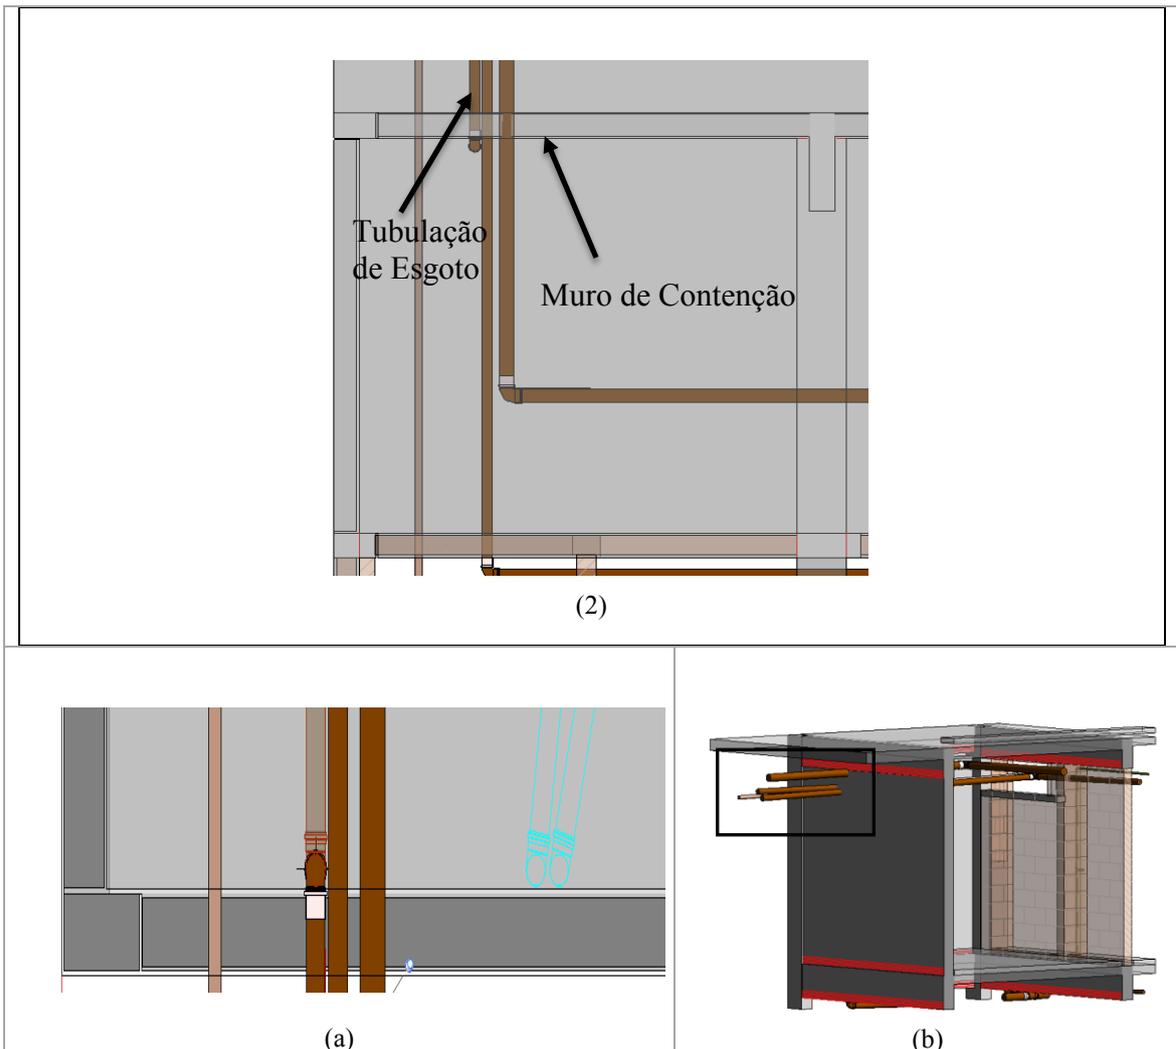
Planta baixa (a) e vista tridimensional (b) de parede de contenção em confronto com tubulação de esgoto. Fonte: elaborado pelos autores
